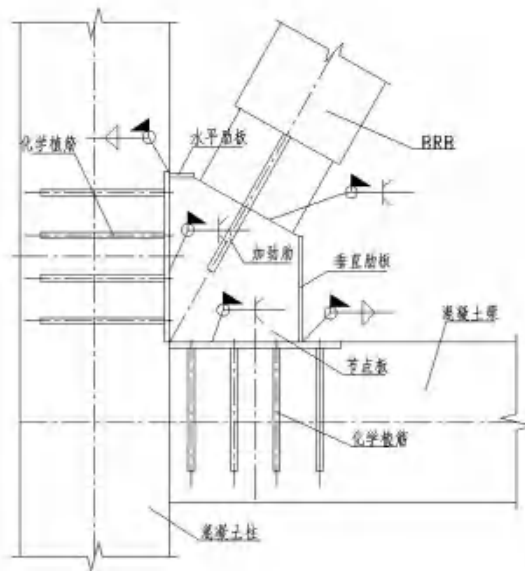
57 既有混凝土结构中 BRB 连接节点（支撑角部）
